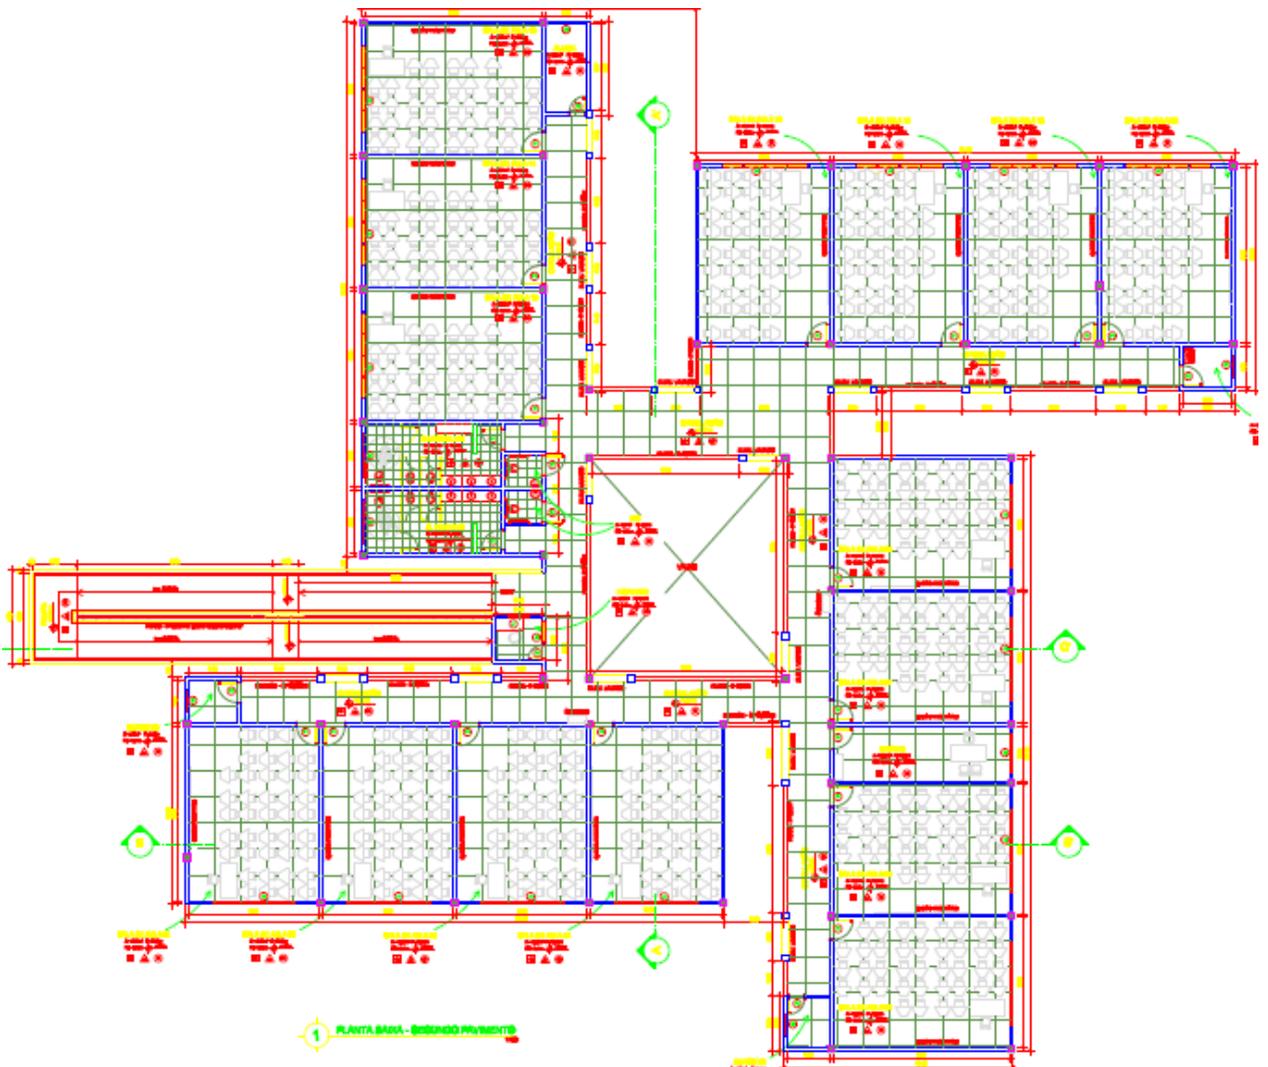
Projeto CE Erich Walter Heine. 2º Pavimento.
